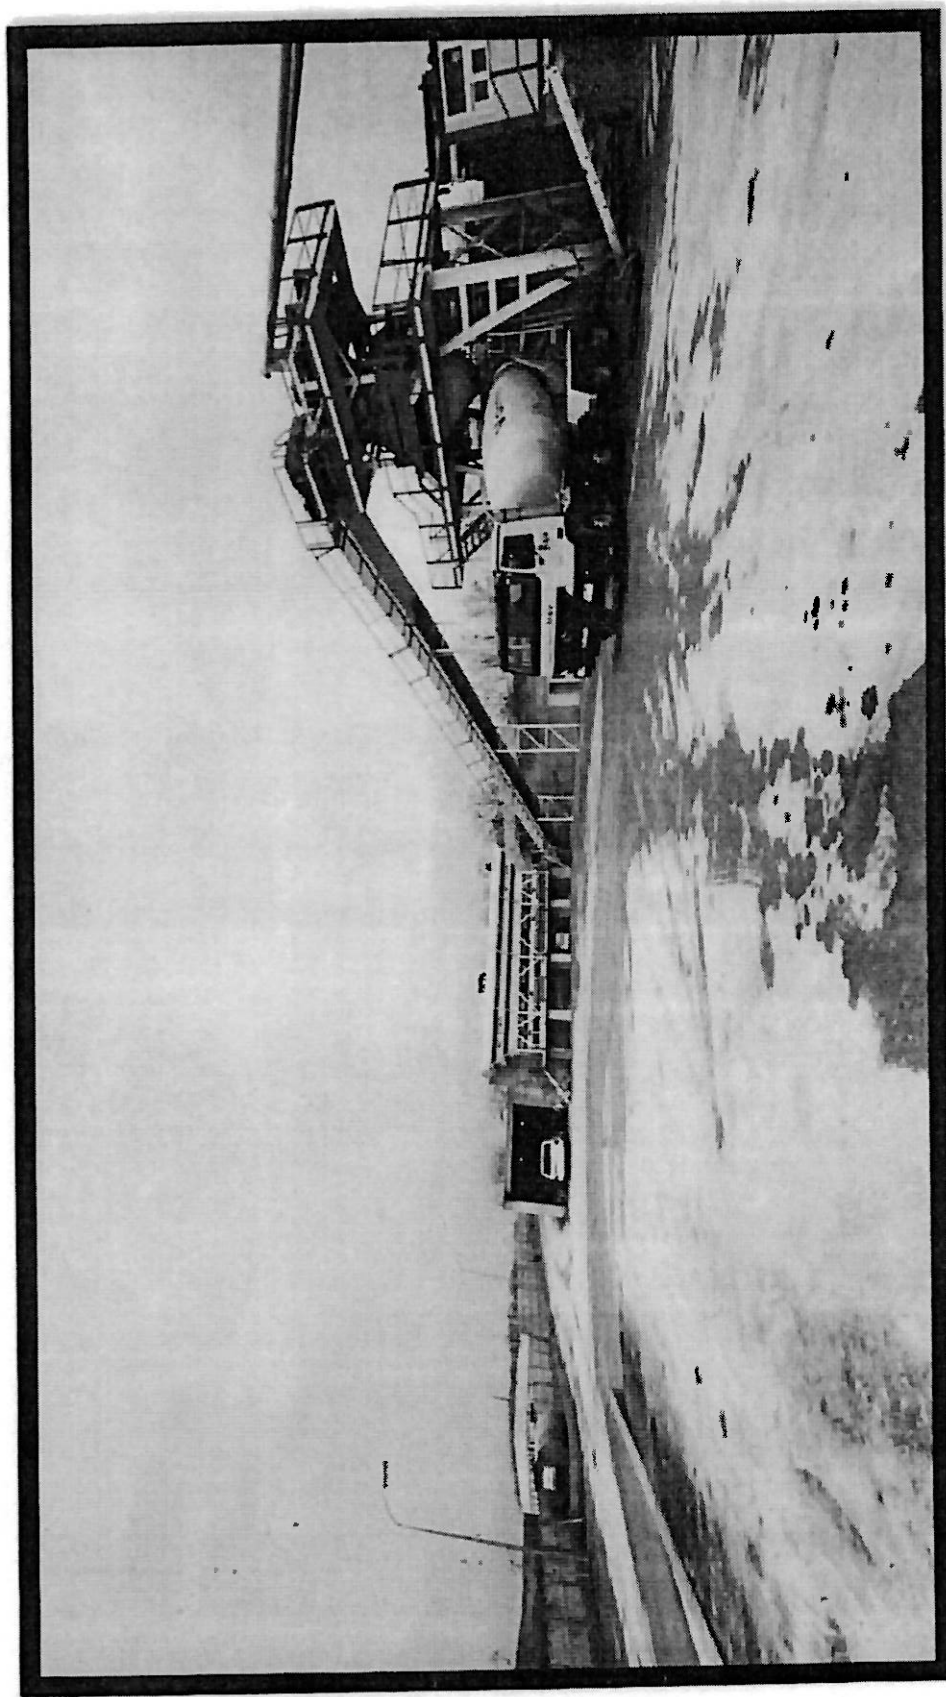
PAMJE E PRODHIMIT TË BETONIT TË LËNGJET.
